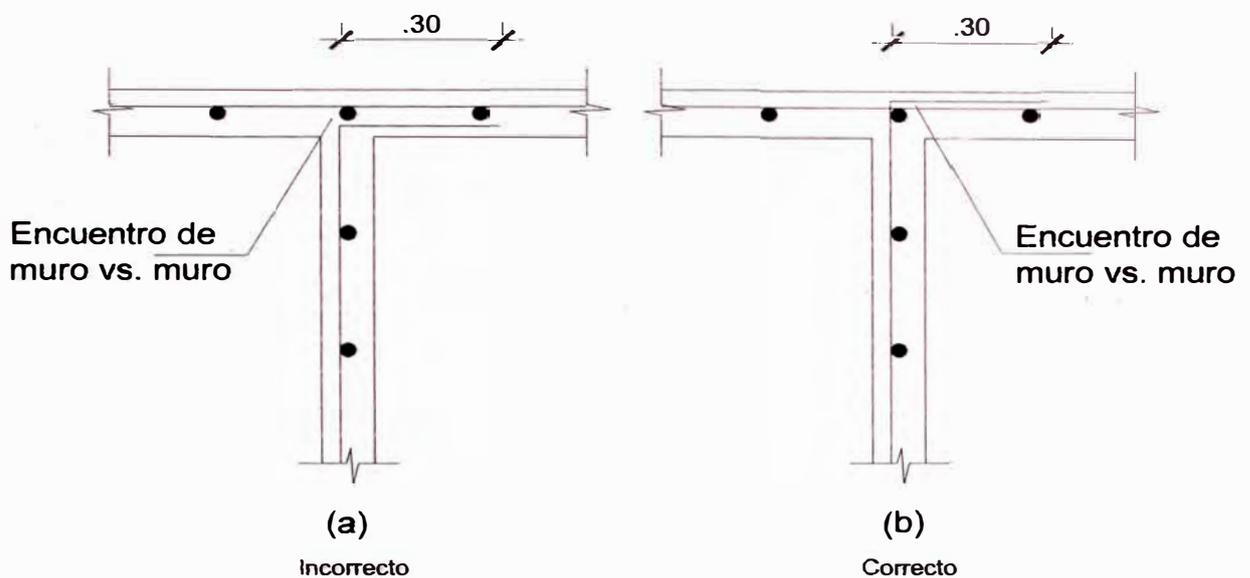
Detalle de colocado de armadura (vista en planta) en intersección de muros con $\varnothing 3/8''$
